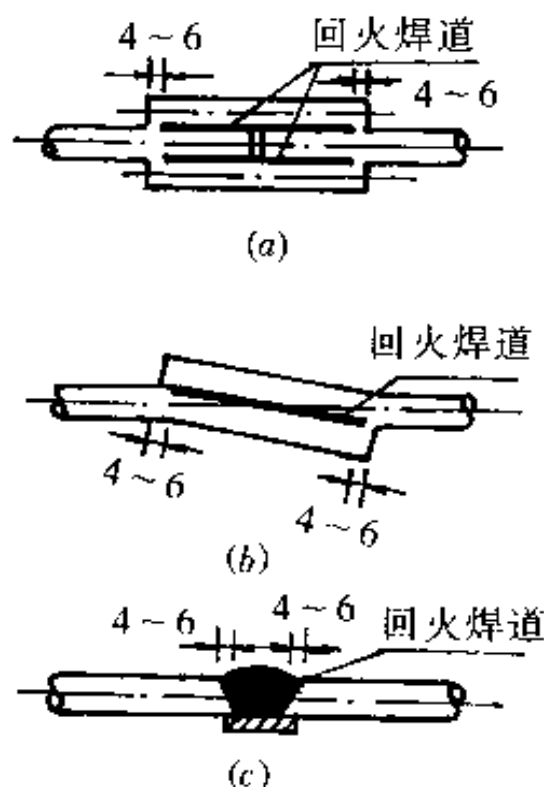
钢筋负温电弧焊回火焊道示意图
